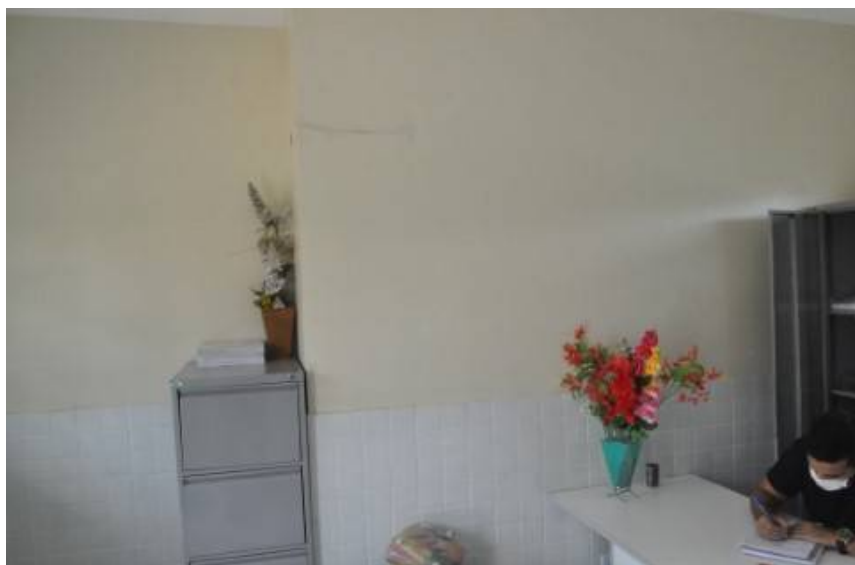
Vista geral: Parede esquerda da coordenação.
